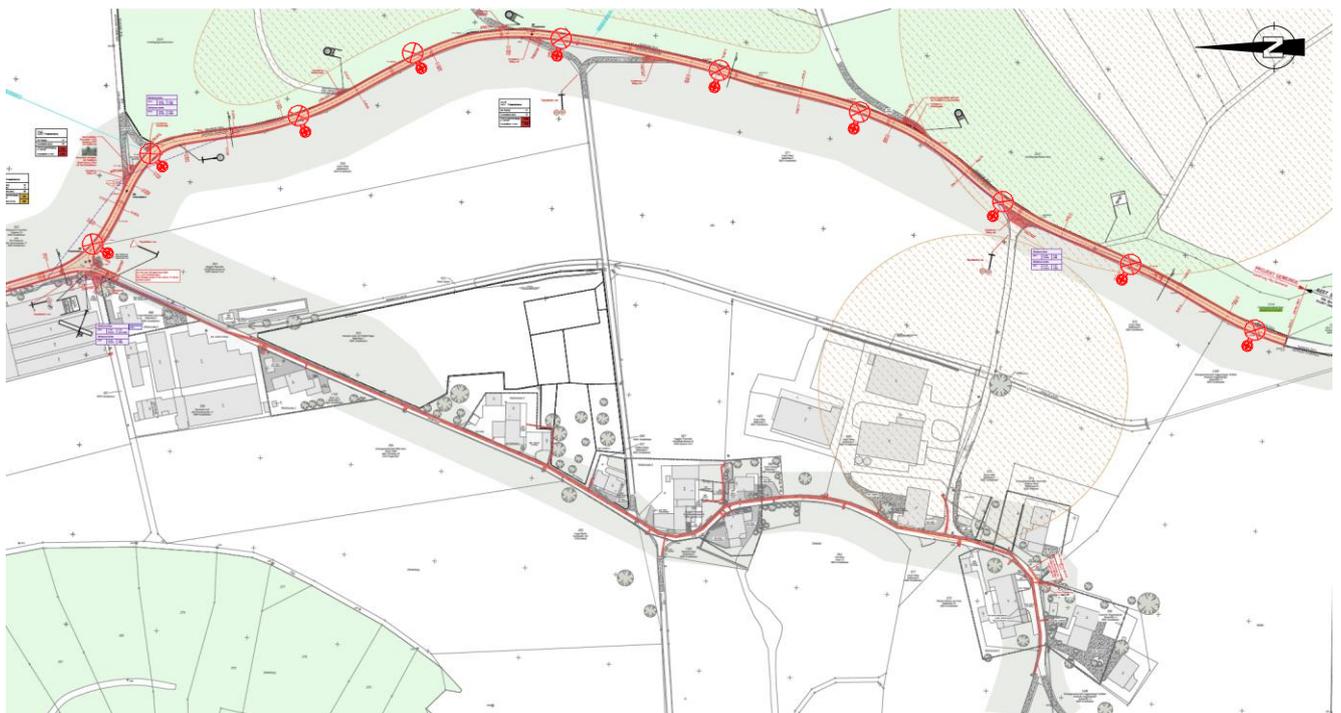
Planausschnitt aus dem Strassenbauplan mit der neuen Beleuchtung im Abschnitt entlang des Waldes
